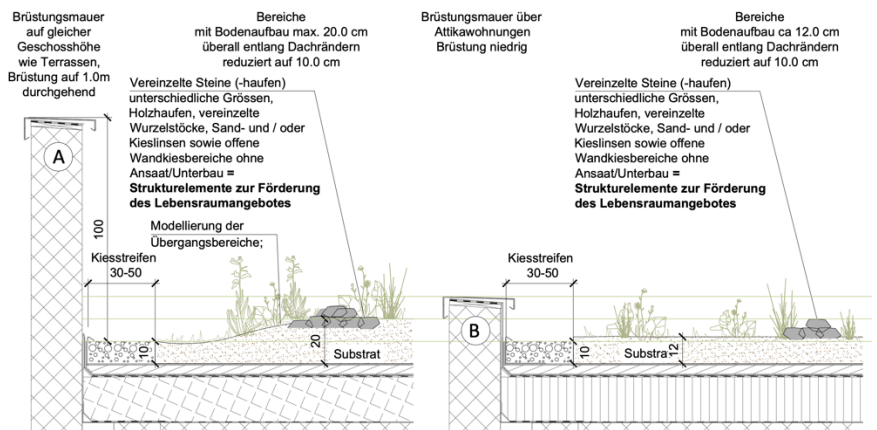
Schemaschnitt Dachaufbau intensiv, vetschpartner Landschaftsarchitekten AG Stand Richtprojekt: 7. März 2023
